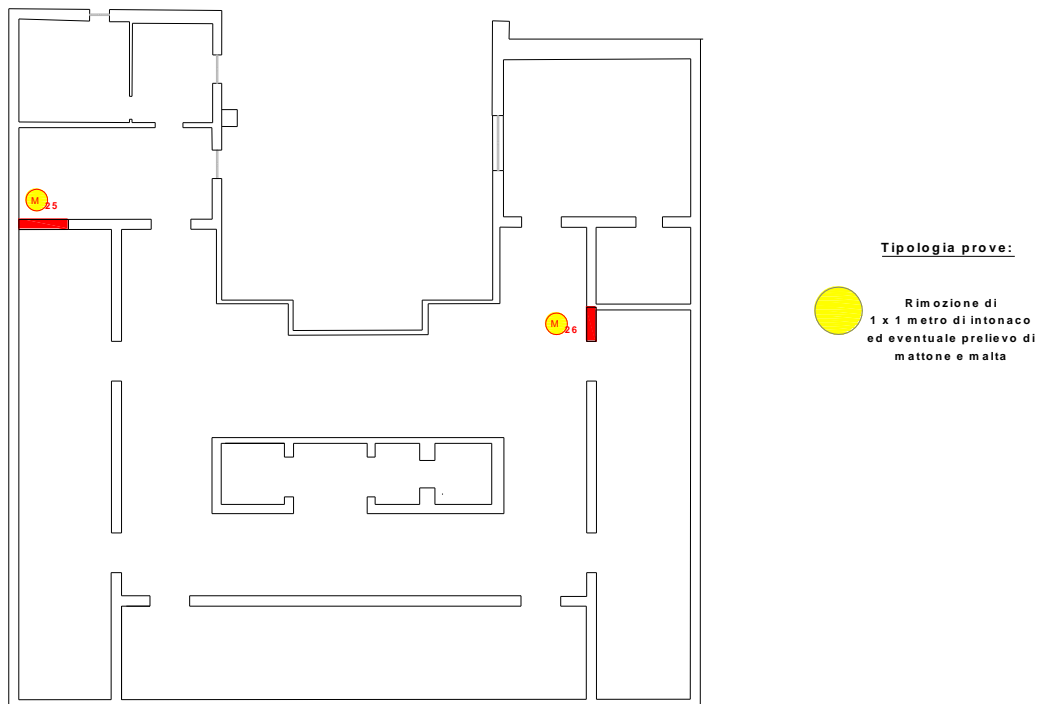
Pianta chiave con indicazione dei punti di sondaggio ai piani quarto e quinto.
